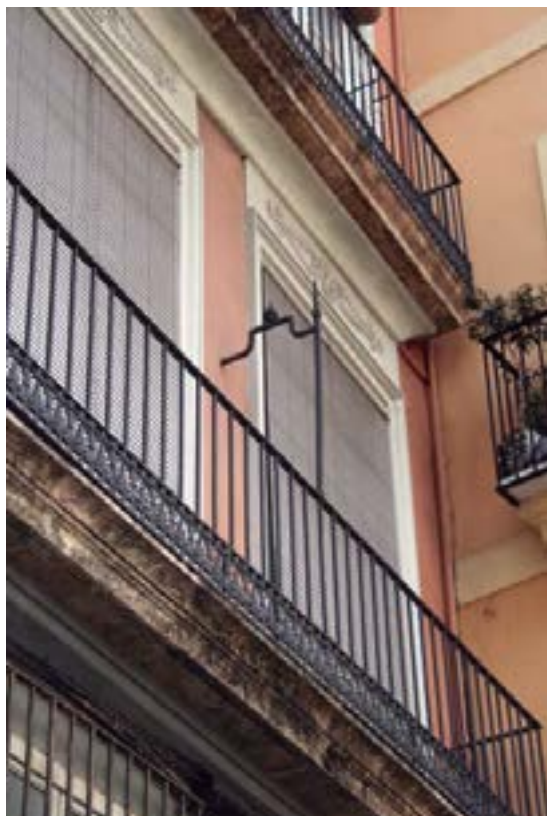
Detalle del balcón de la primera planta de la casa n.17 de calle Gobernador Viejo, 17. (PP)
